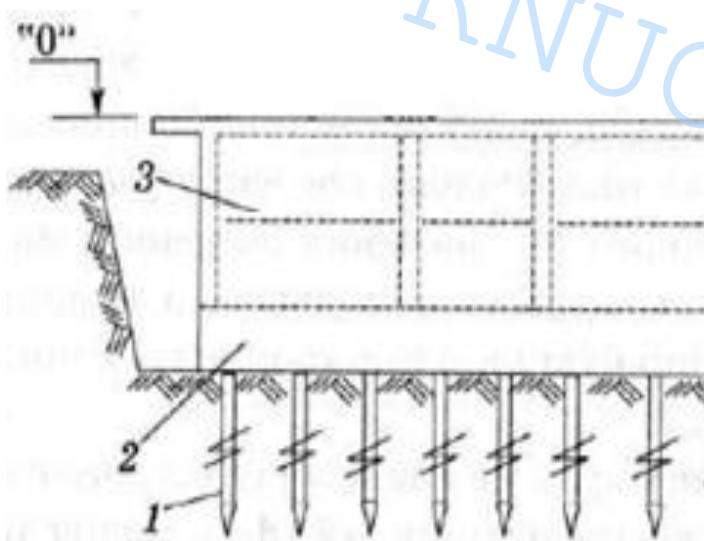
Узагальнена схема підземної частини споруди: 1 – палі, 2 – фундаментна плита, 3 – підвальна частина споруди, створена на залізобетонних колонах
